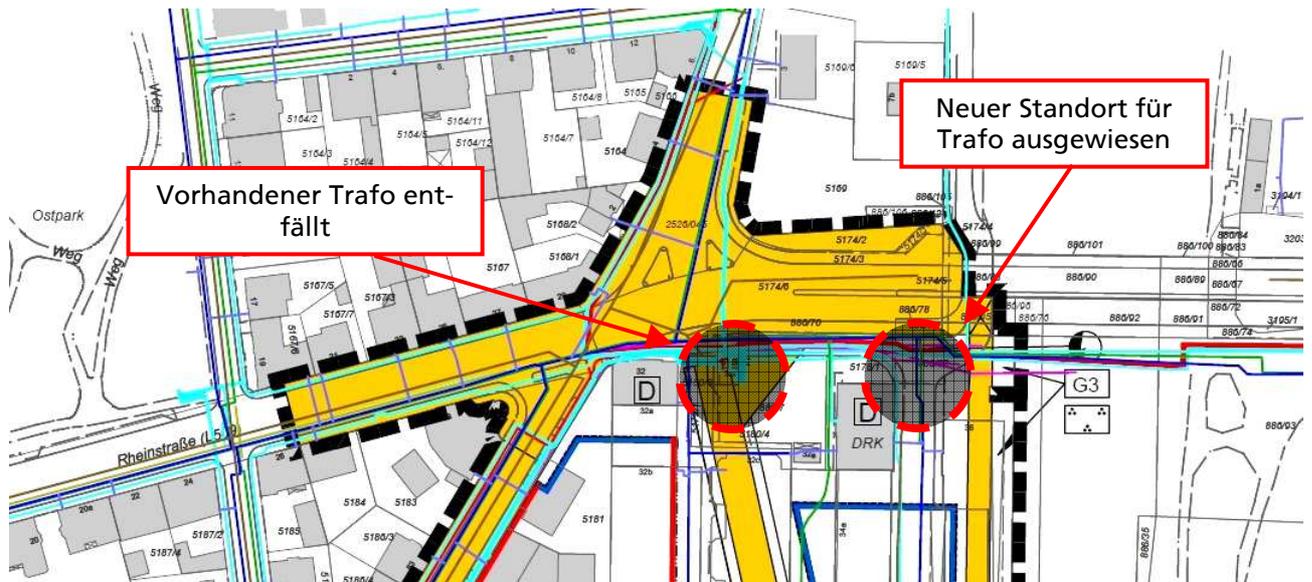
Relevante Bereiche zur Berücksichtigung im Planverfahren (ohne Maßstab), Stand 19.04.2011
